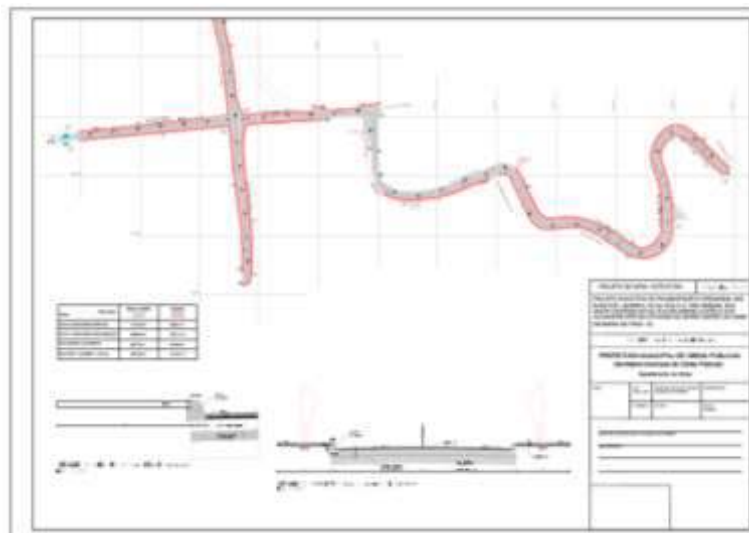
Prancha 05/16 – Projeto de Pavimentação.
